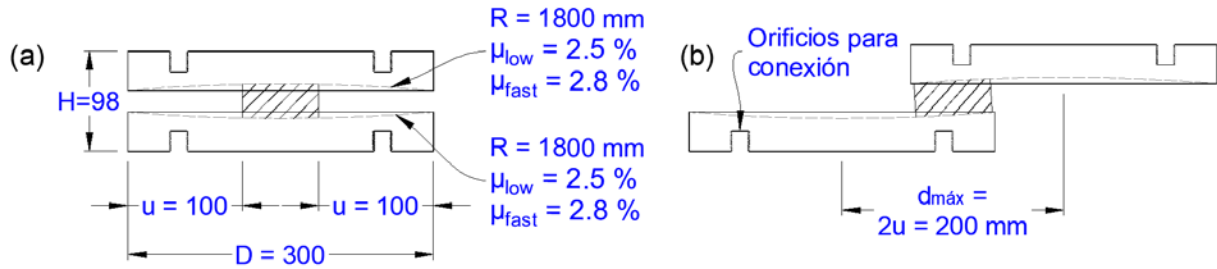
Aislador FPS definitivo (dimensiones en mm)
